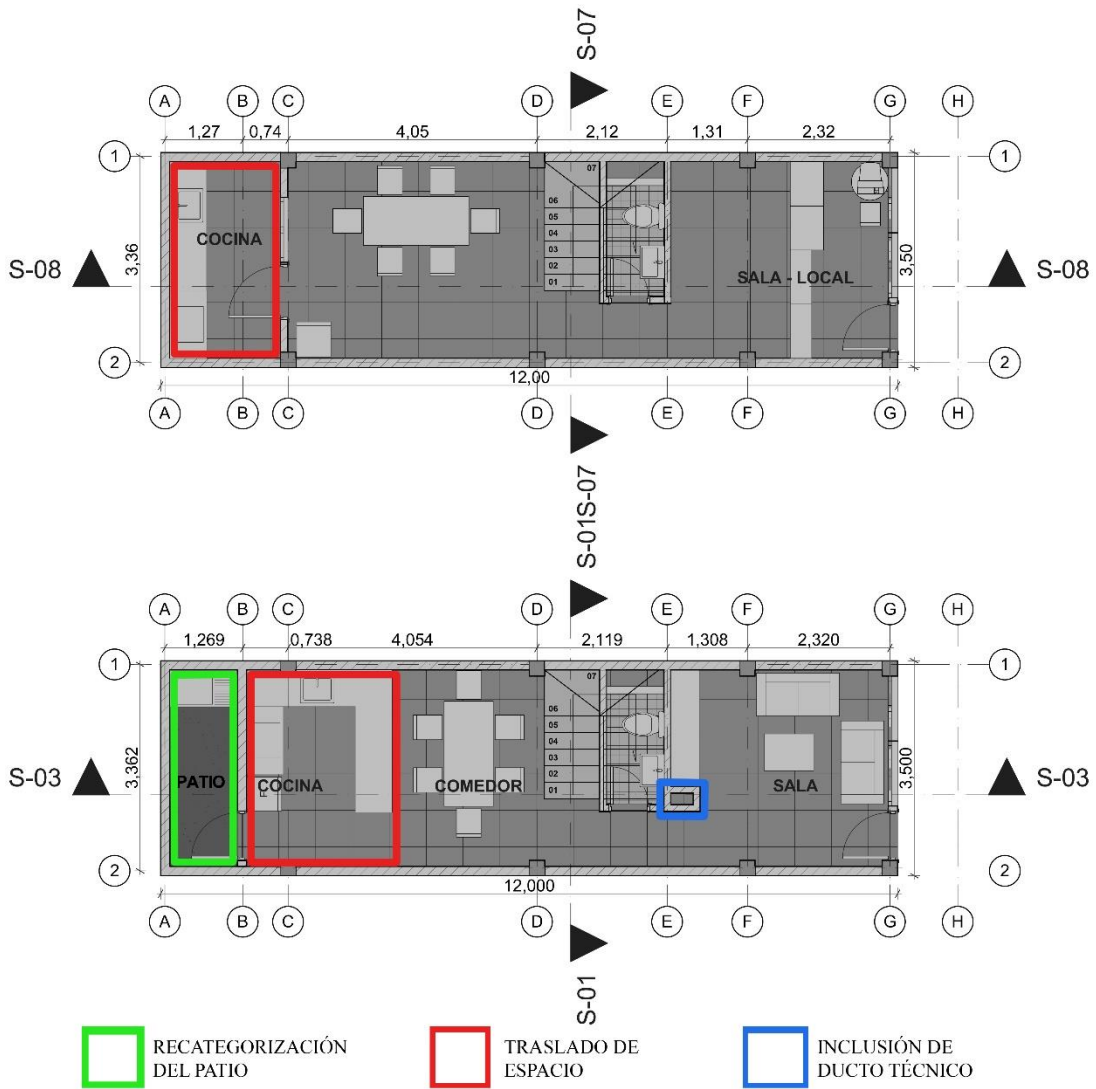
Plano de primer nivel (existente y propuesto).Elaboración propia 2017.
